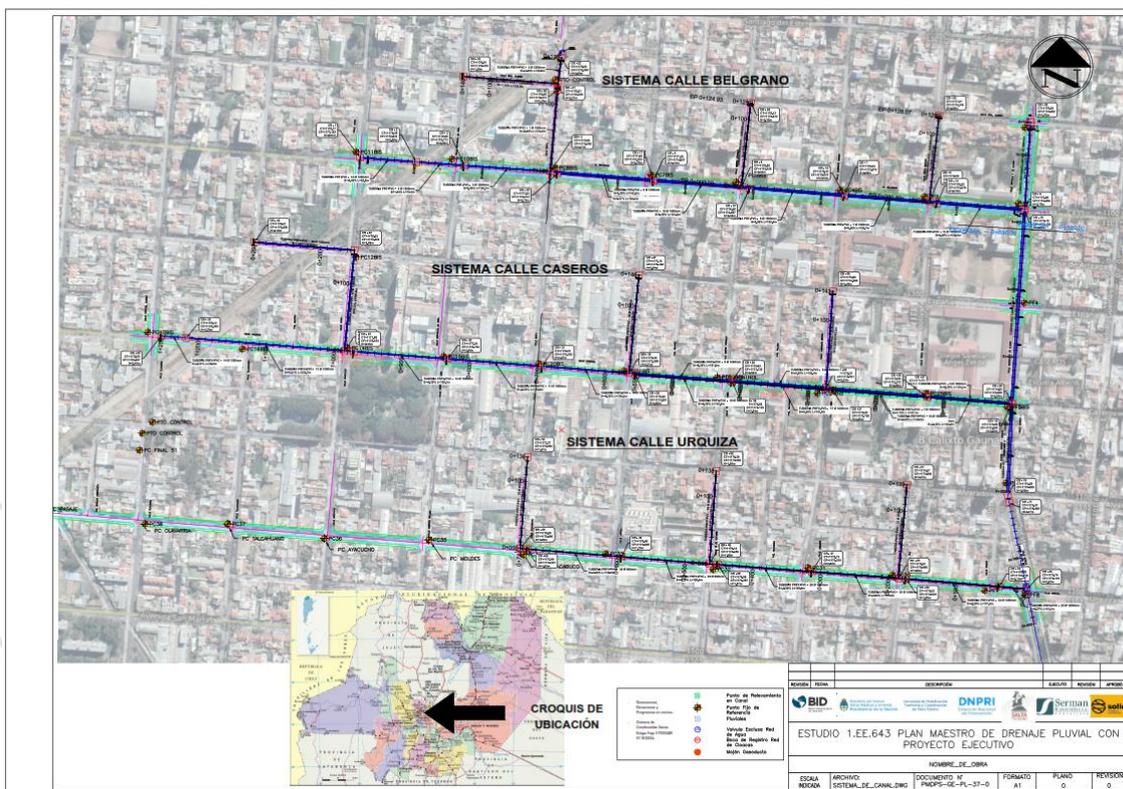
Plan Maestro de drenaje Pluvial – Canal Alvear y Canales Projectados en la Cuenca Caseros - Alvear
